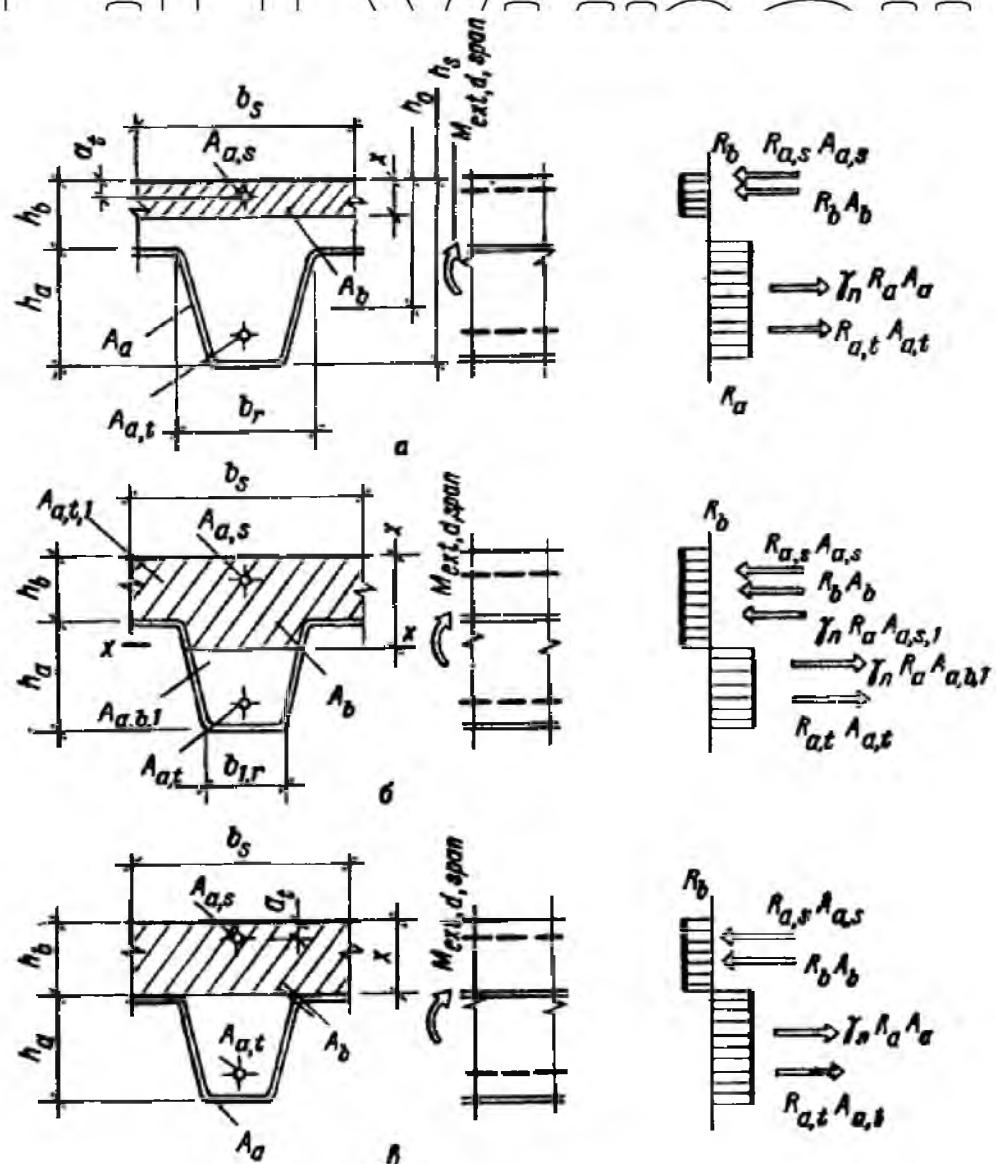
Схема зусиль та епюри напружень в перерізі, нормальному до повздовжньої осі плити при розташуванні нейтральної осі: а – в межах товщини перерізу плити $x < h_b$; б – в межах перерізу ребра $x > h_b$; в – виподілці настилу $x = h_b$
